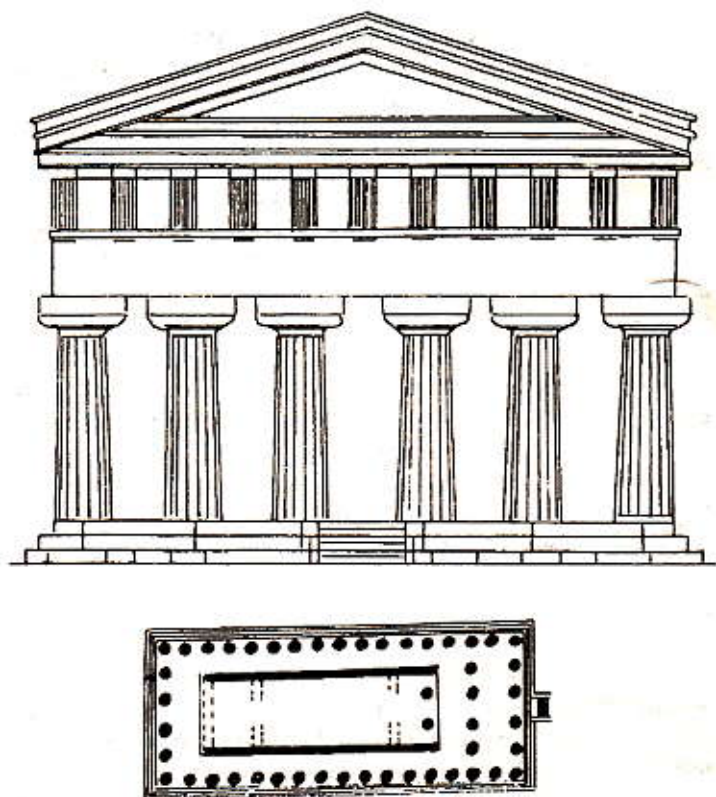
Гигантомания в храме Аполлона, фасад, план
